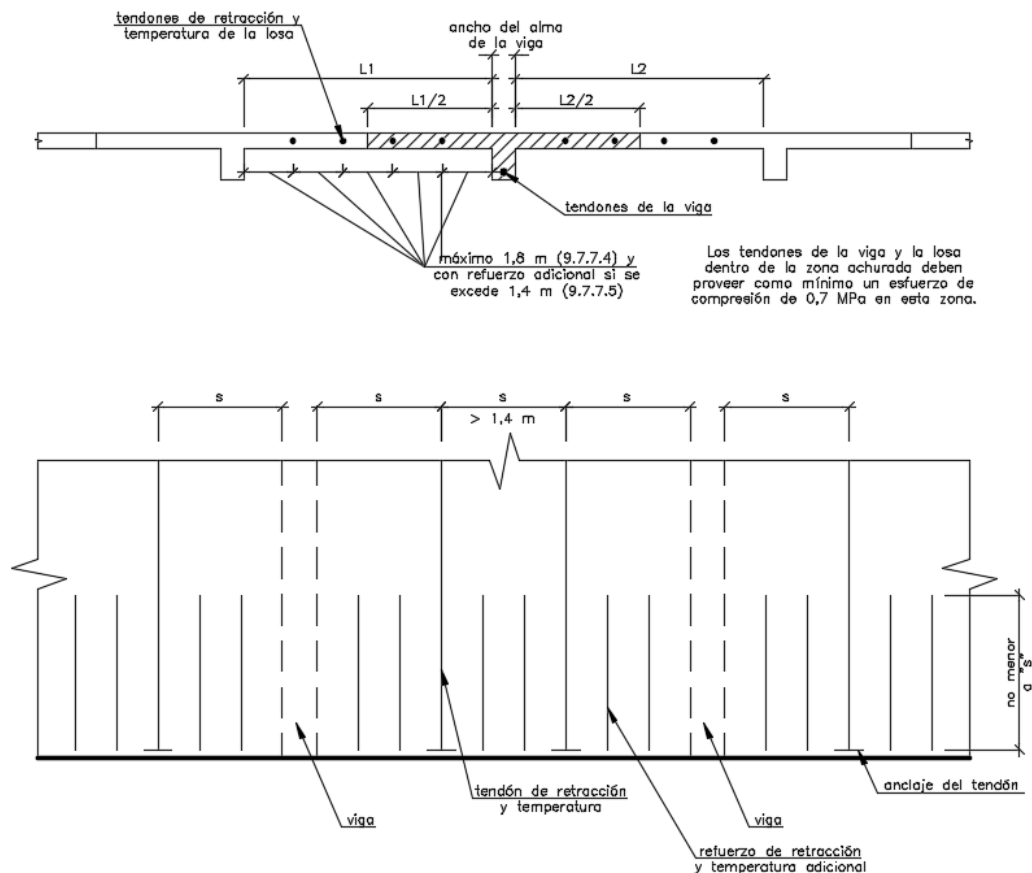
Acero de preesfuerzo utilizado como refuerzo de retracción y temperatura en una losa.
